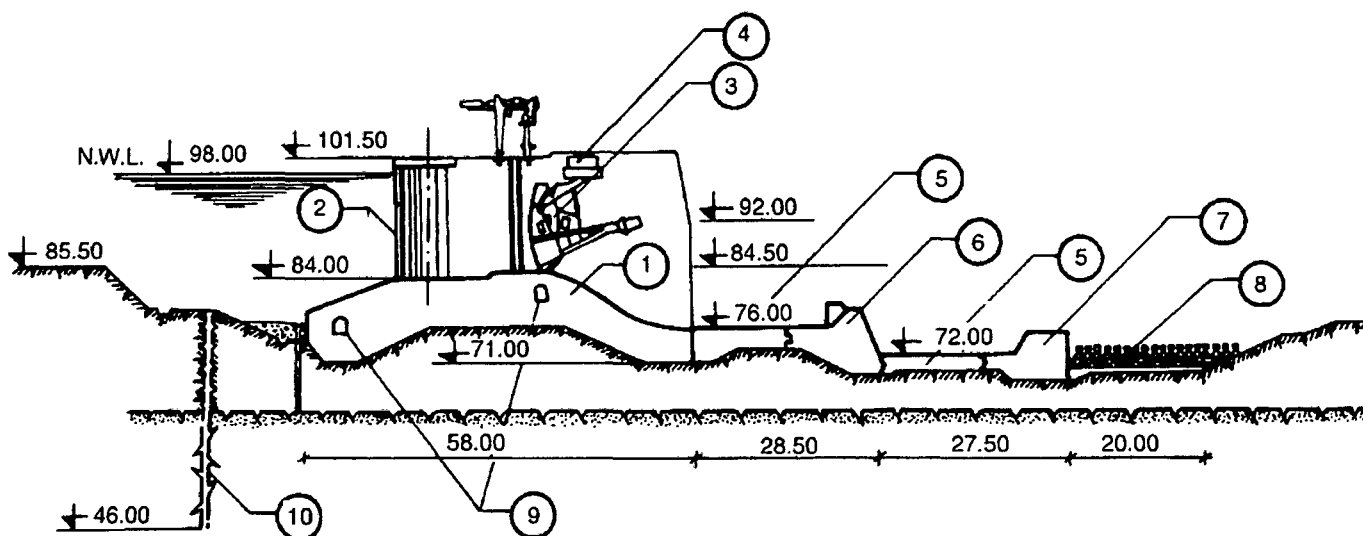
Coupe transversale du barrage mobile d'Ipotesti (Roumanie)
